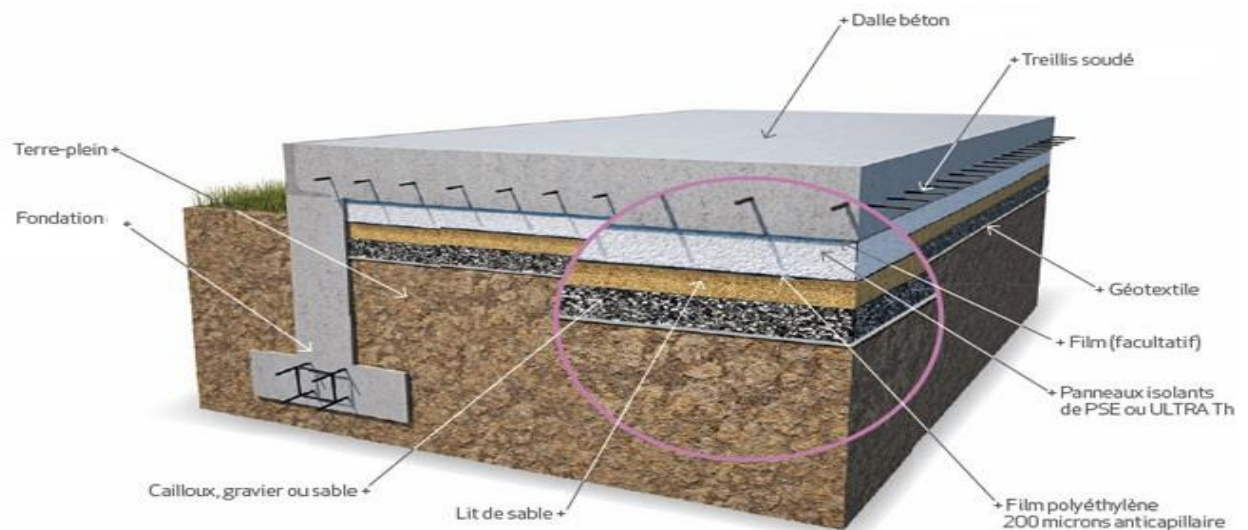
Schéma de dalle flottante sur terre-plein.
